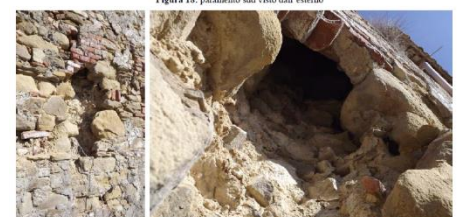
Cavità muraria verticale per la realizzazione di pluviale
